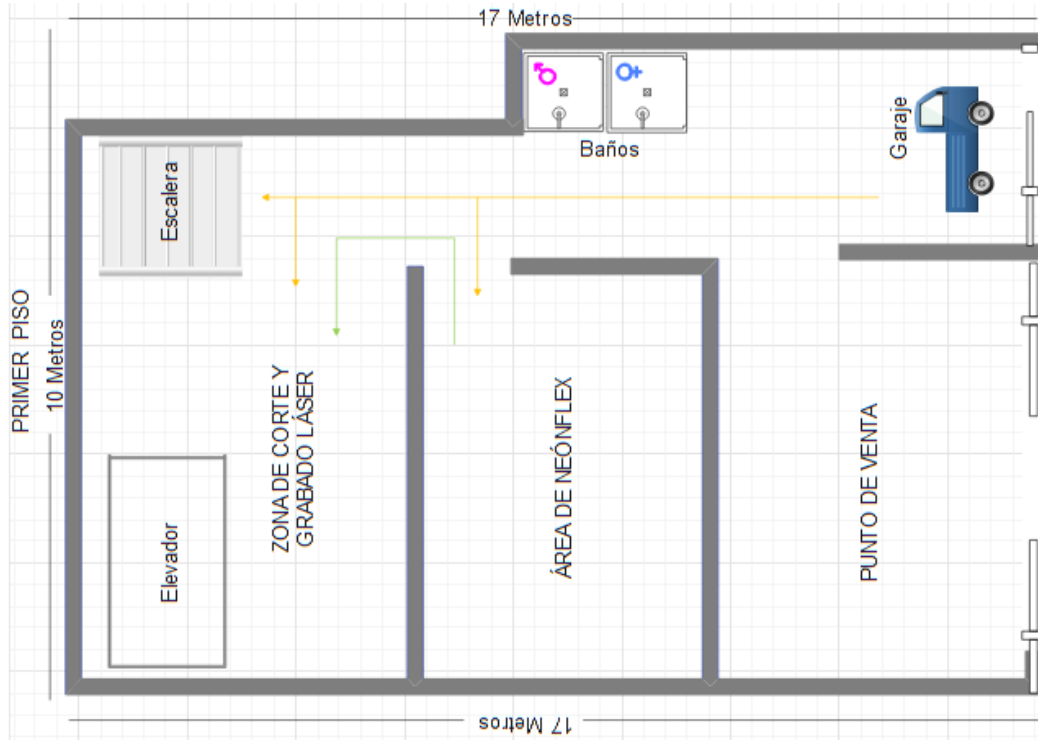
Propuesta de mejora de la distribución de planta Primer piso. Elaboración propia
